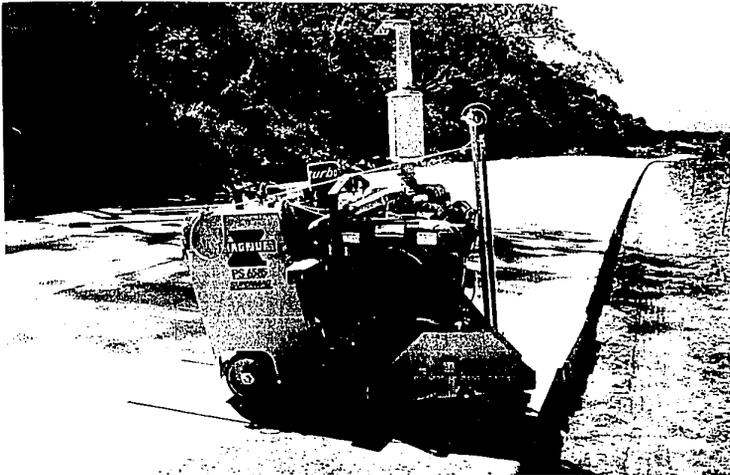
JUNTAS TRANSVERSALES, PAVIMENTO CON REFUERZO CONTINUO
